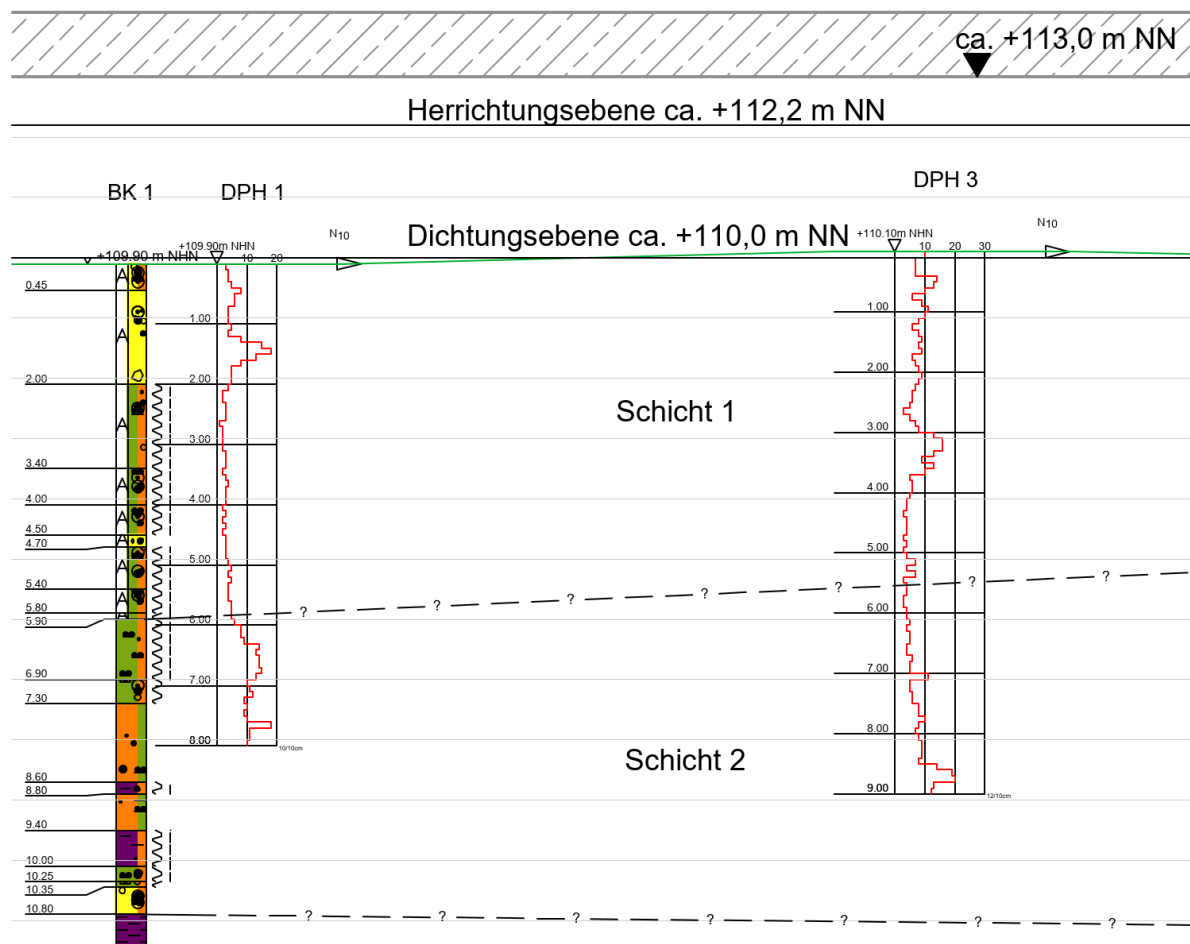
Baugrundschnitt mit Dichtungsfolie (Gutachten Dr. Spang, 2021).
